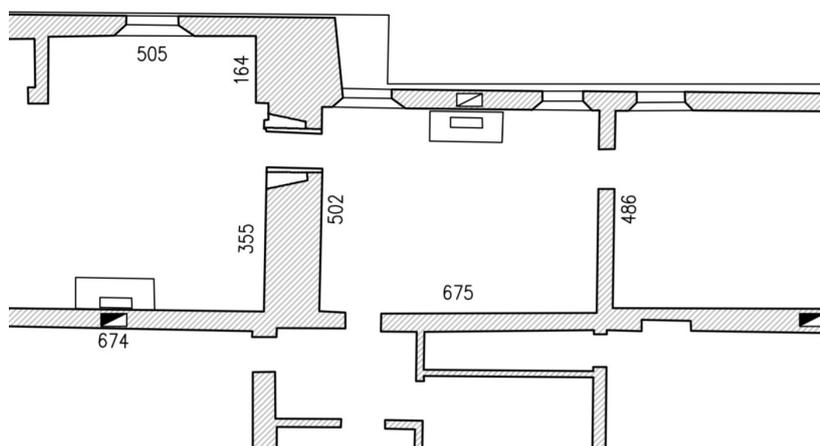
Quinta camera della galleria. Planimetria attuale del primo piano della Rocca di Novellara.
